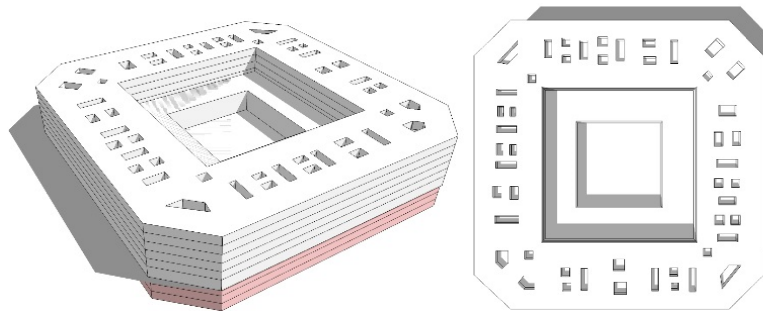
En 2002 se reduce la protección únicamente a la fachada. (fuente propia)
